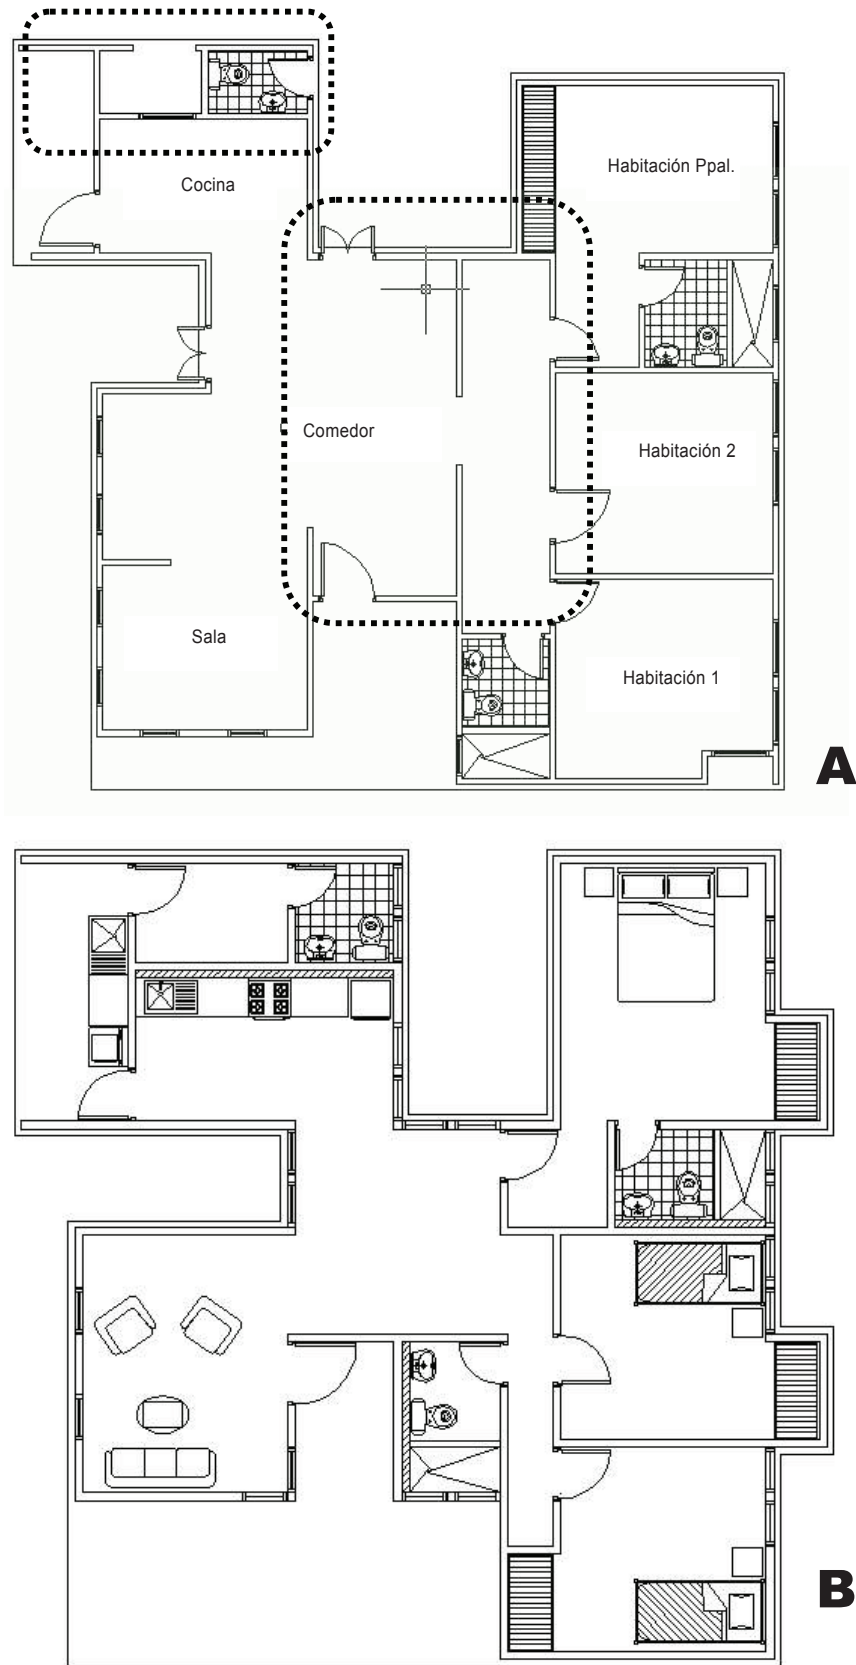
(A) Planta original del Modelo 2 Vivienda Aislada tipo rural (148,0 m²) de CVG Proforca. (B) Planta rediseñada con 132,30 m² de área construida, definida por los autores.
